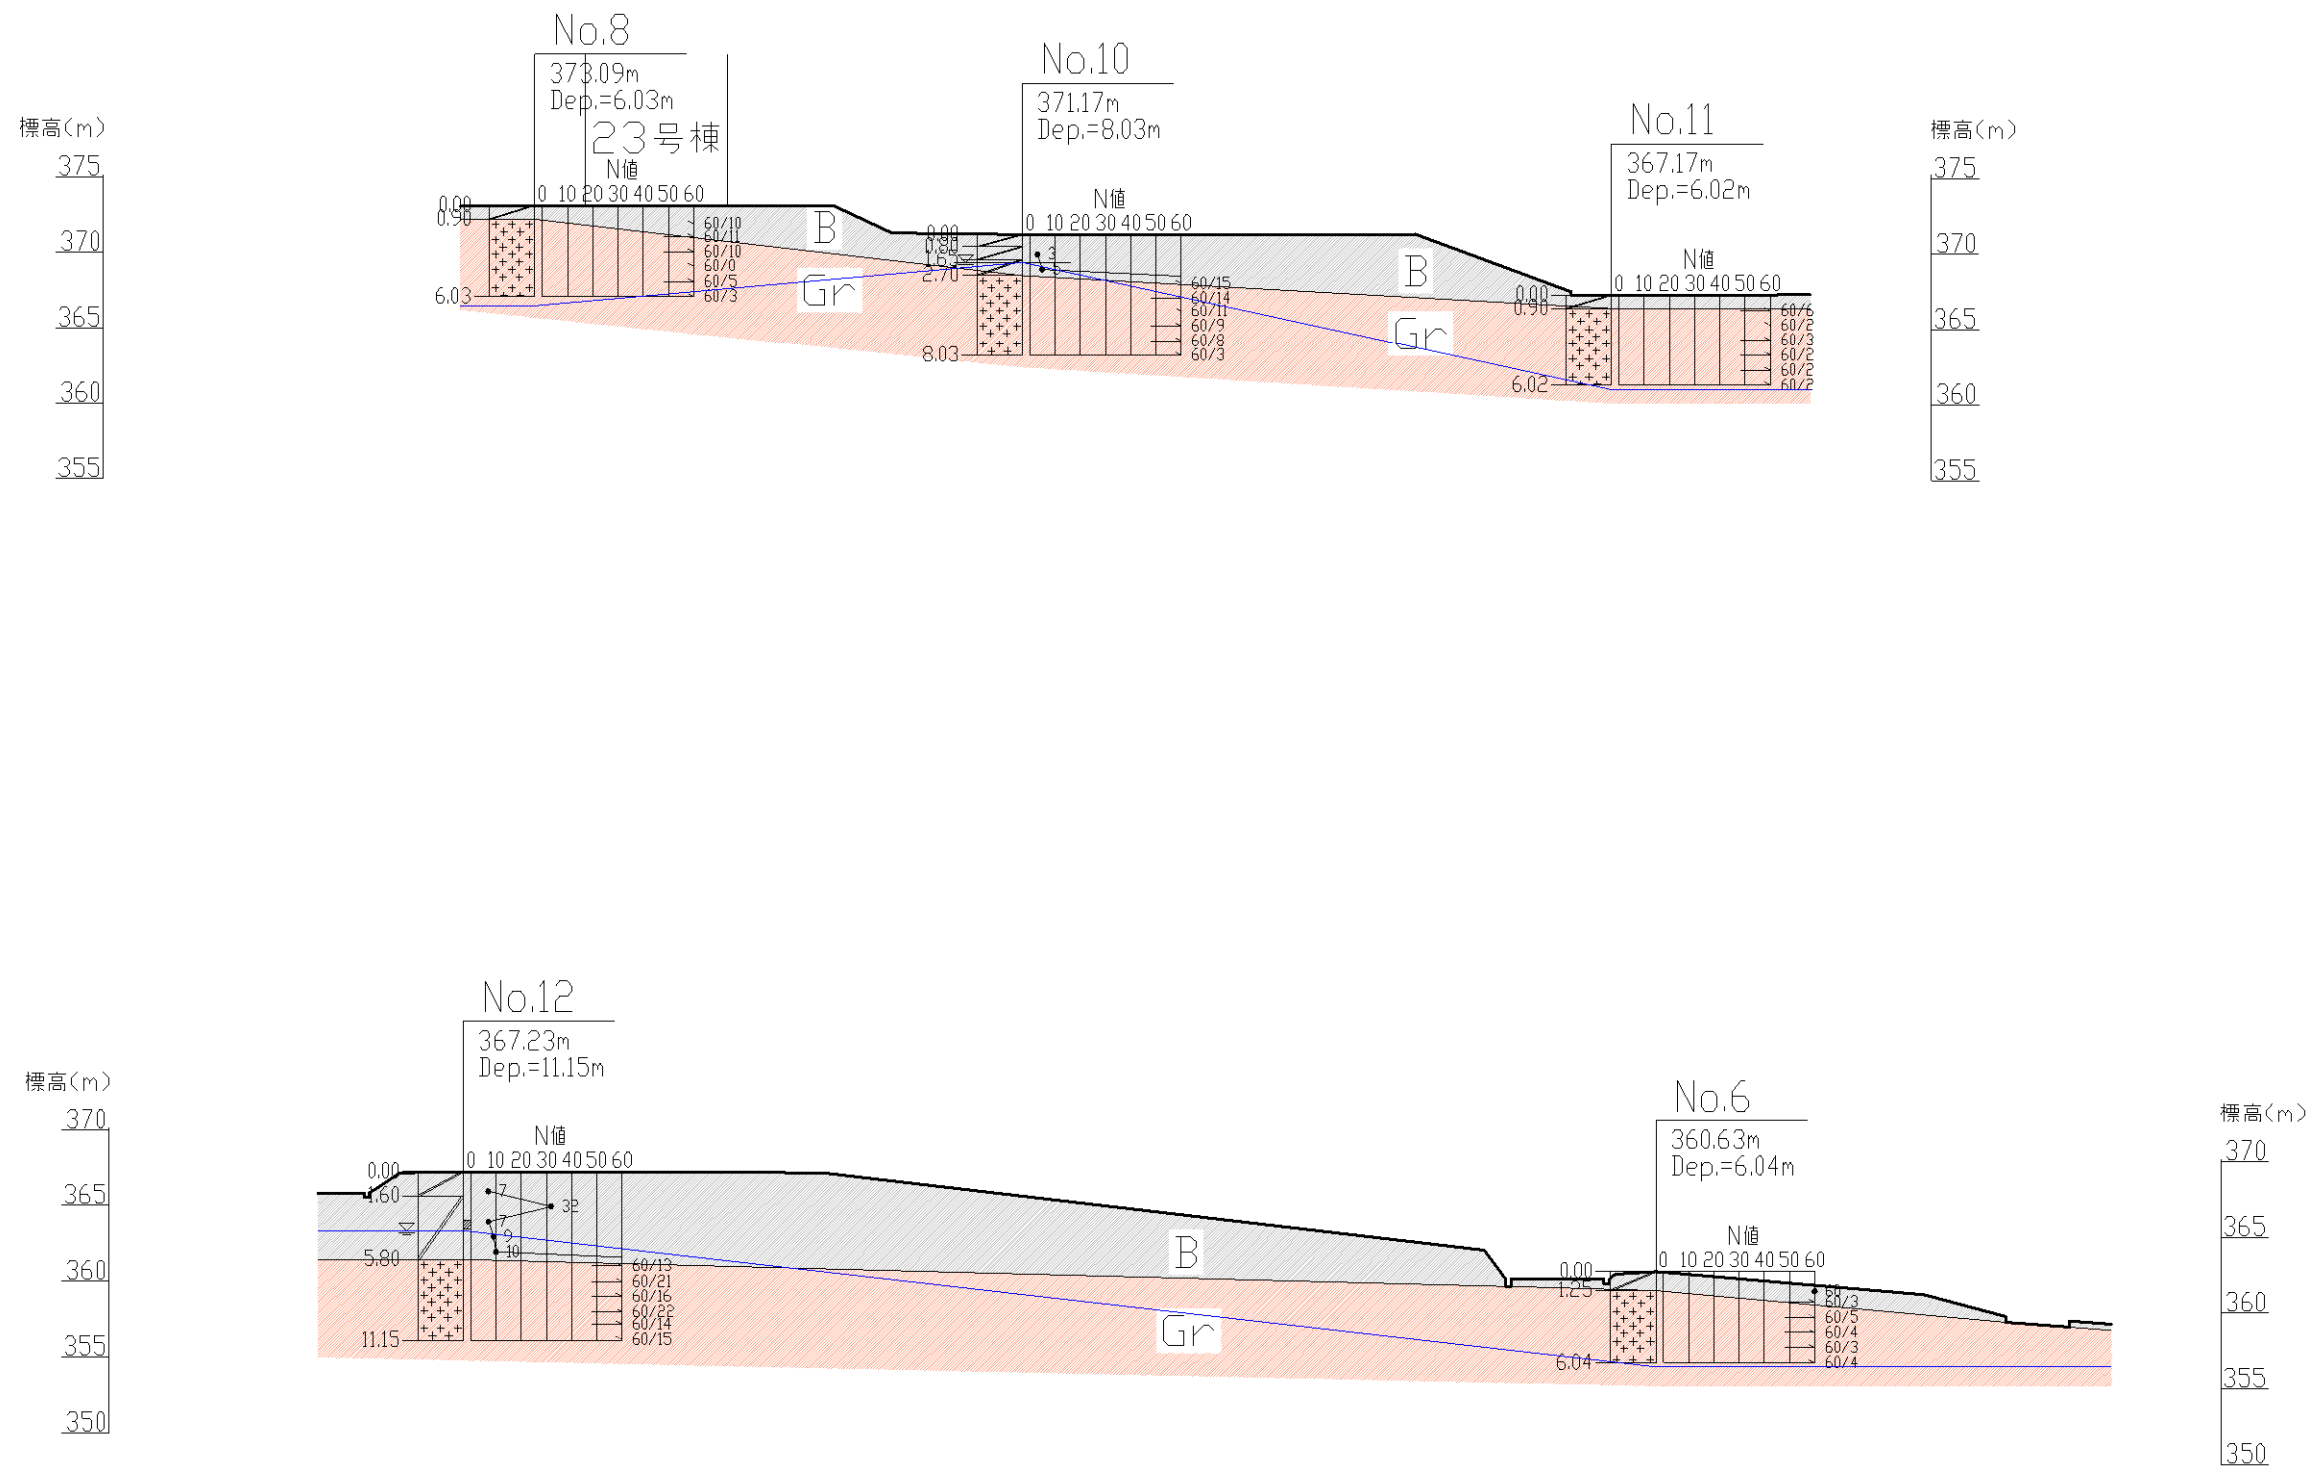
推定地質断面图 (No. 8~11、No. 12~6) (S=1/500:A3)
